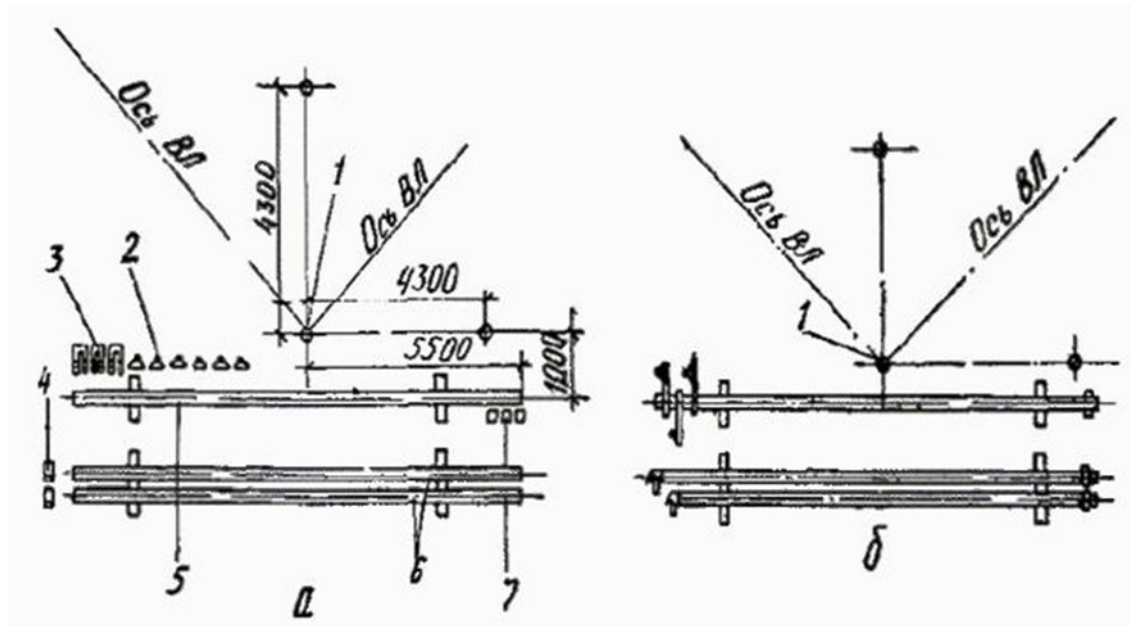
4.1. Сборка железобетонных опор на пикете
